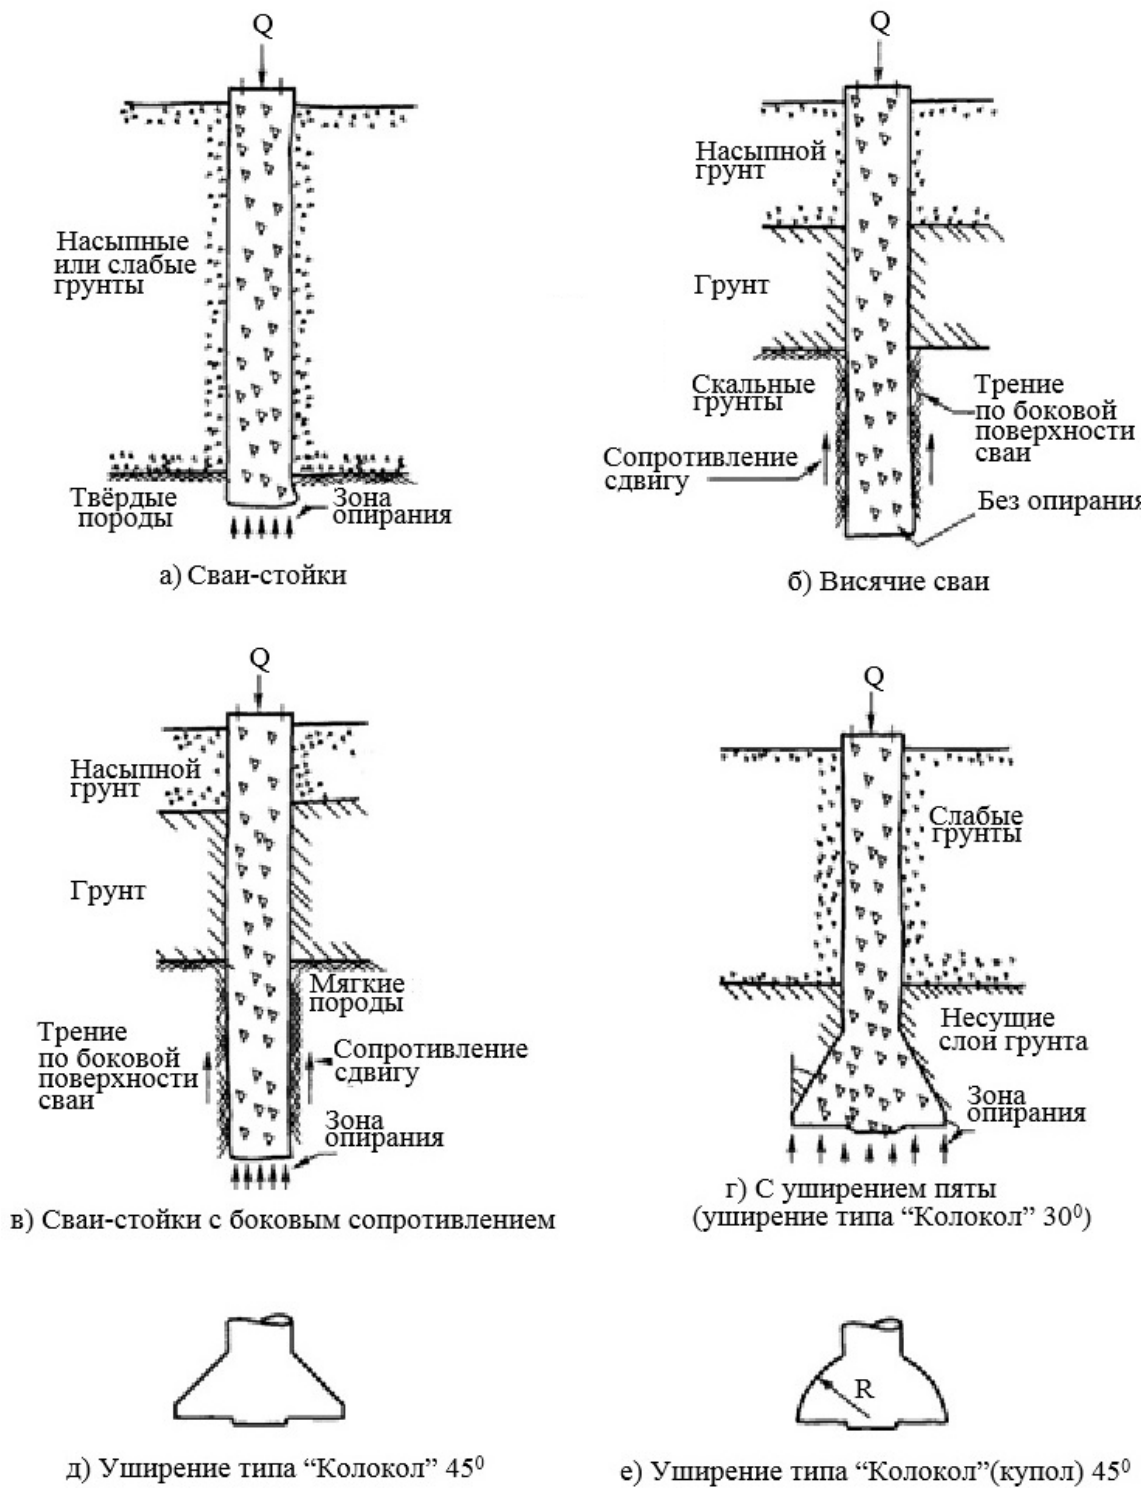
Типы буронабивных свай по способу опирания в грунтовом основании
